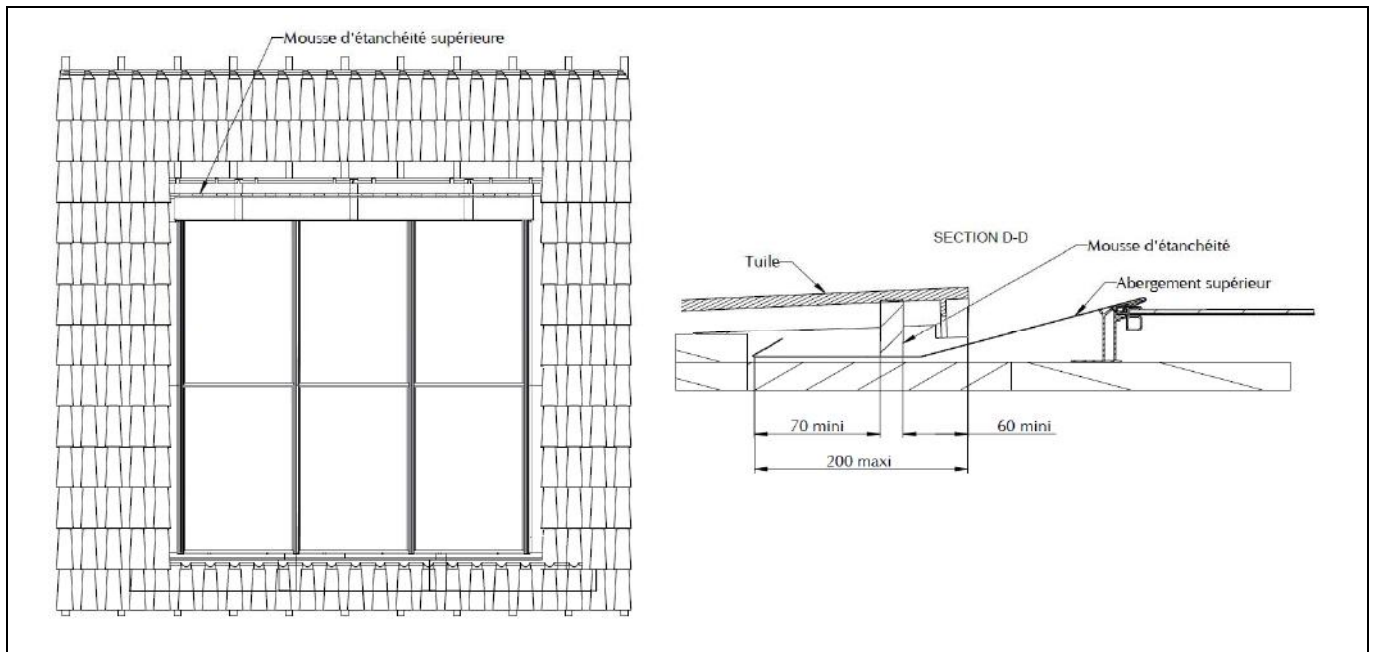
Pose de la mousse d'étanchéité haute pour installation sur toiture tuile
